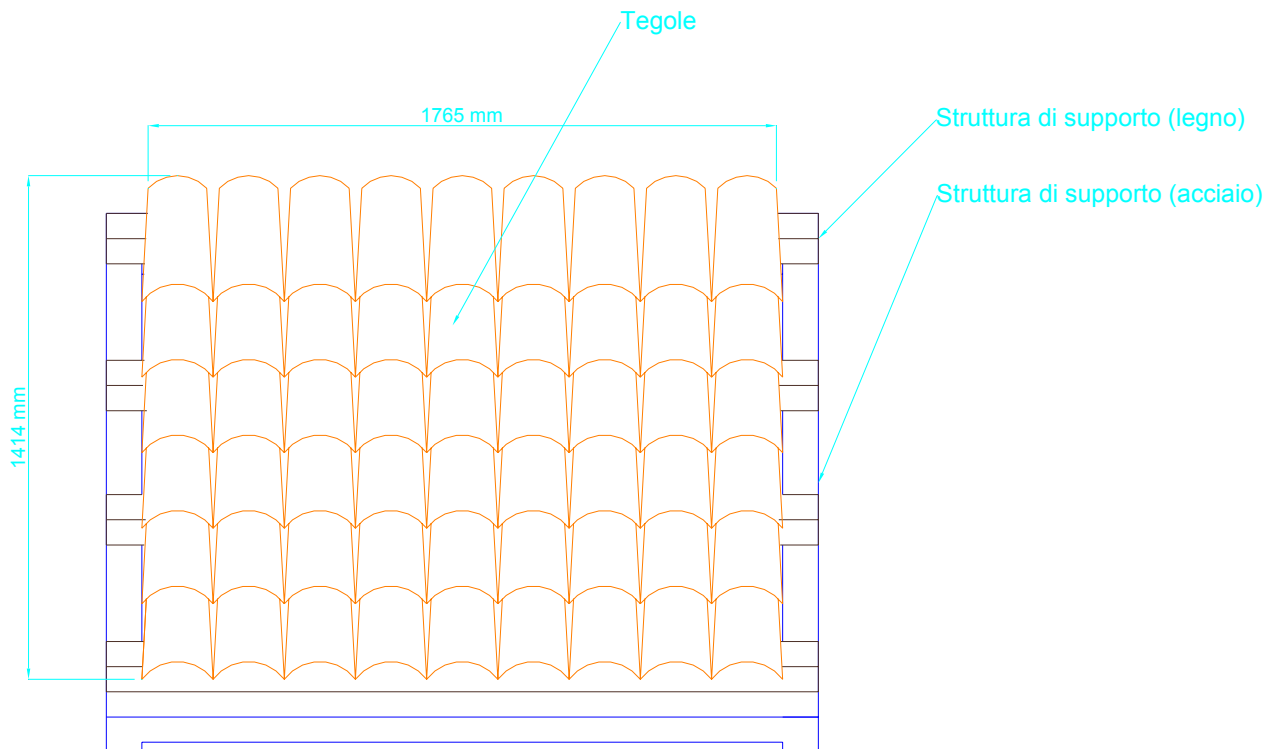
vista frontale della struttura di supporto con la disposizione delle tegole
